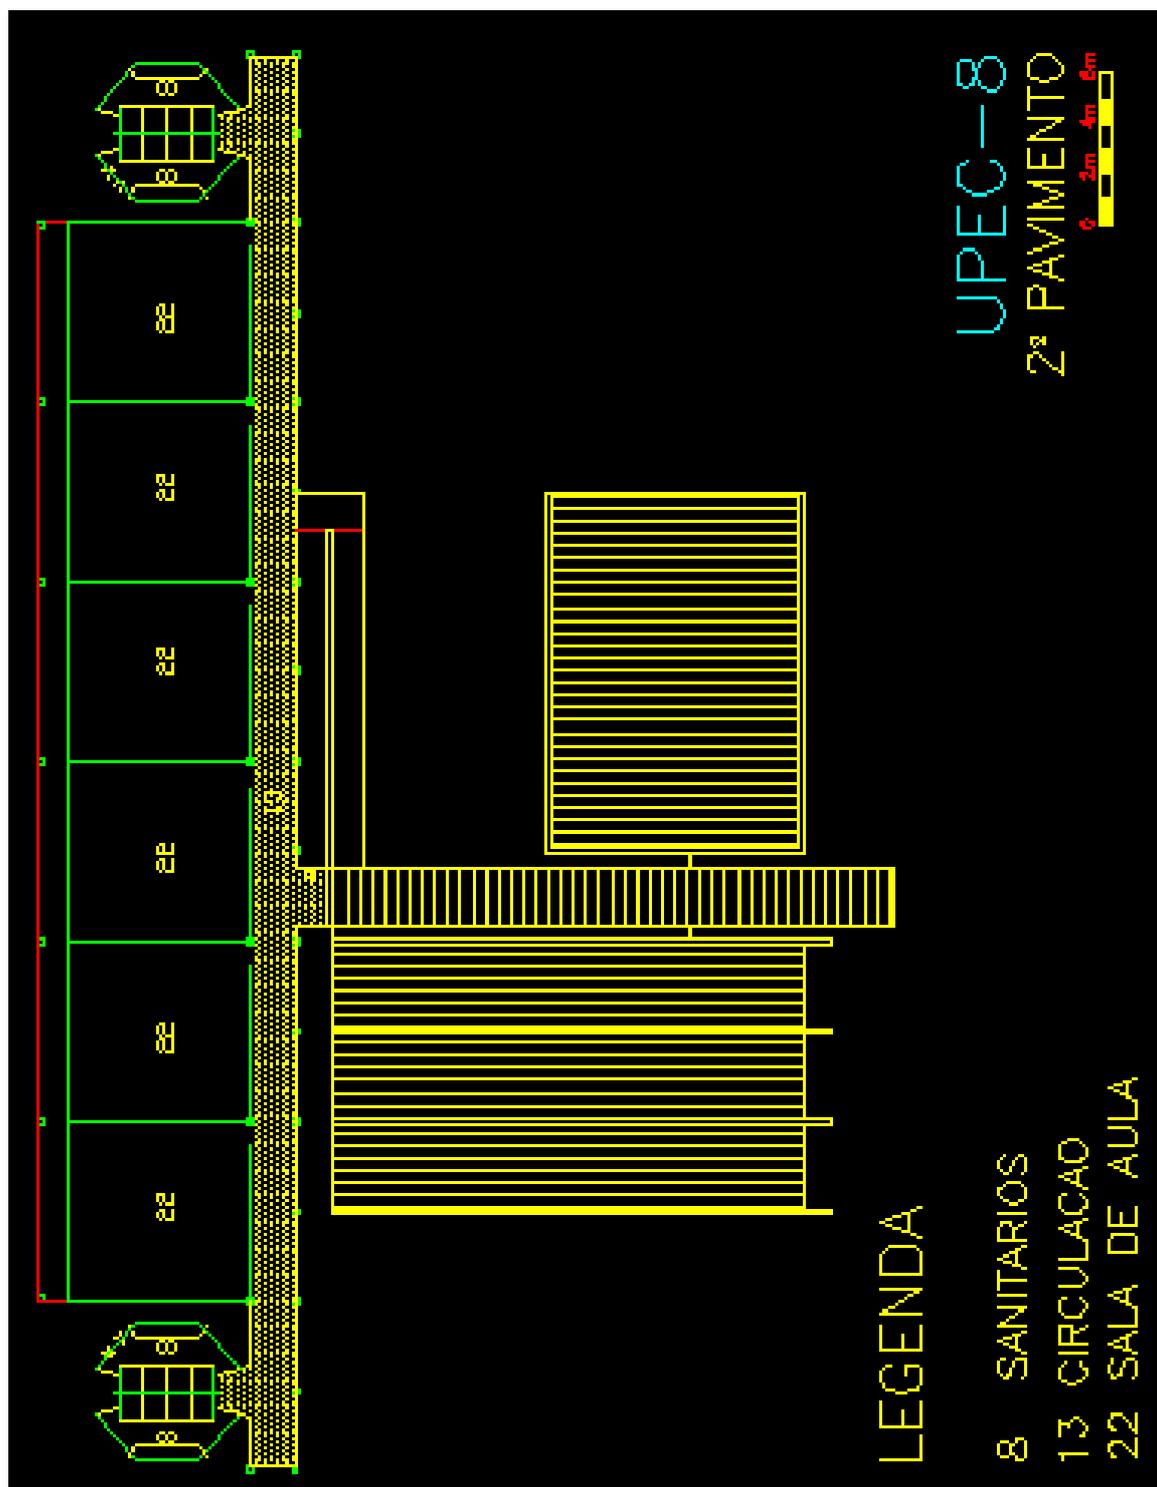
UPEC-8 / PLANTA 2º NÍVEL
